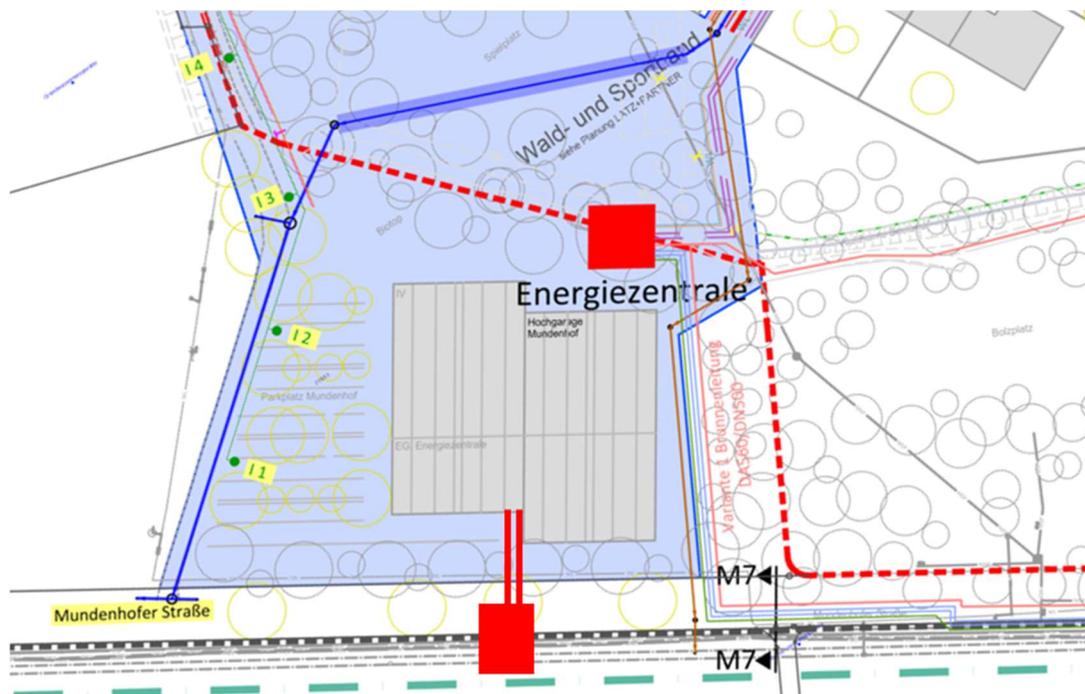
Anordnung des Entnahmebauwerks in der Variante 2 (Bypass, Kartenausschnitt nicht genordet, Hintergrund: Koordinierter Leitungsplan, Übersichtslageplan, Plan-Nr. 00SO2LK01001, Stand 15.10.2019))
